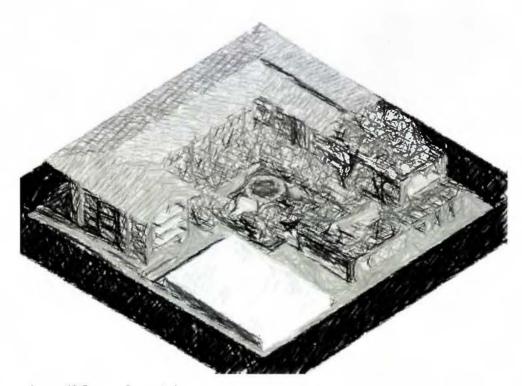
Esquema Propuesta J Fuente: Elaboración Propia
